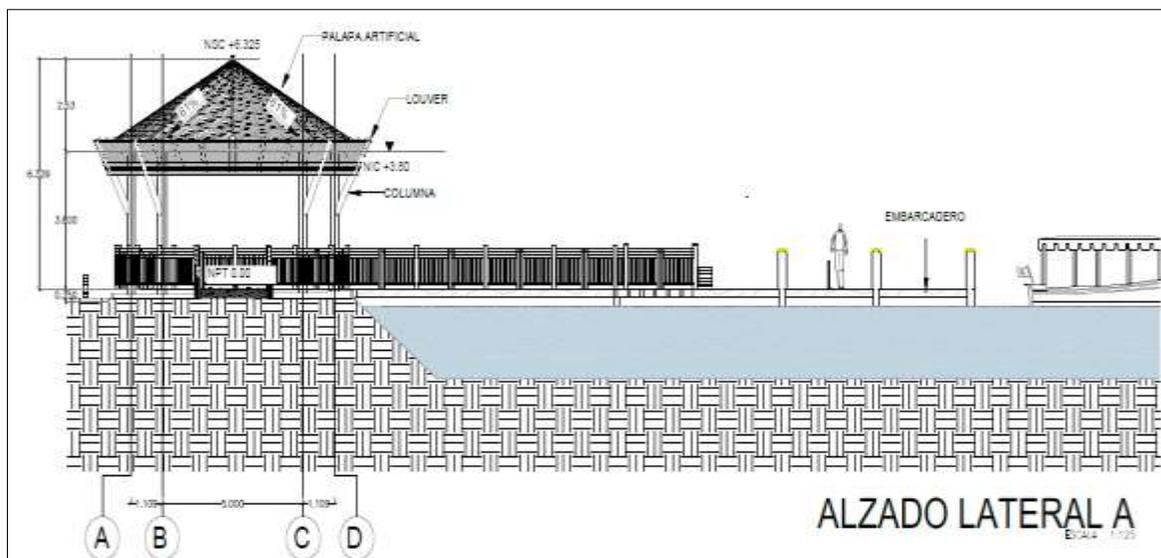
VISTA EN ALZADO LATERAL DE LA DE LA PLATAFORMA DE MUELLE (EMBARCADERO).
